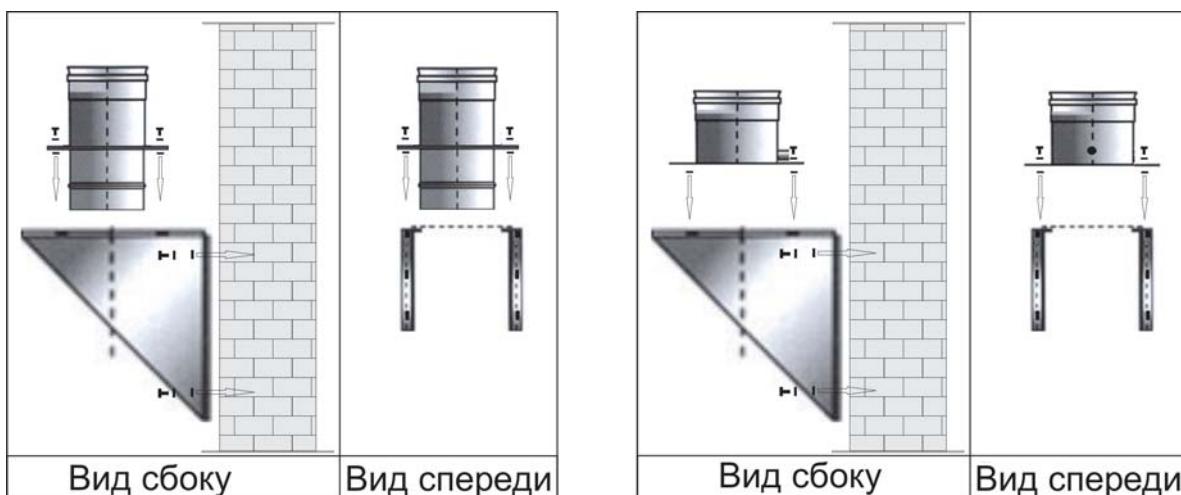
а. Установка пары креплений с промежуточной пластиной
